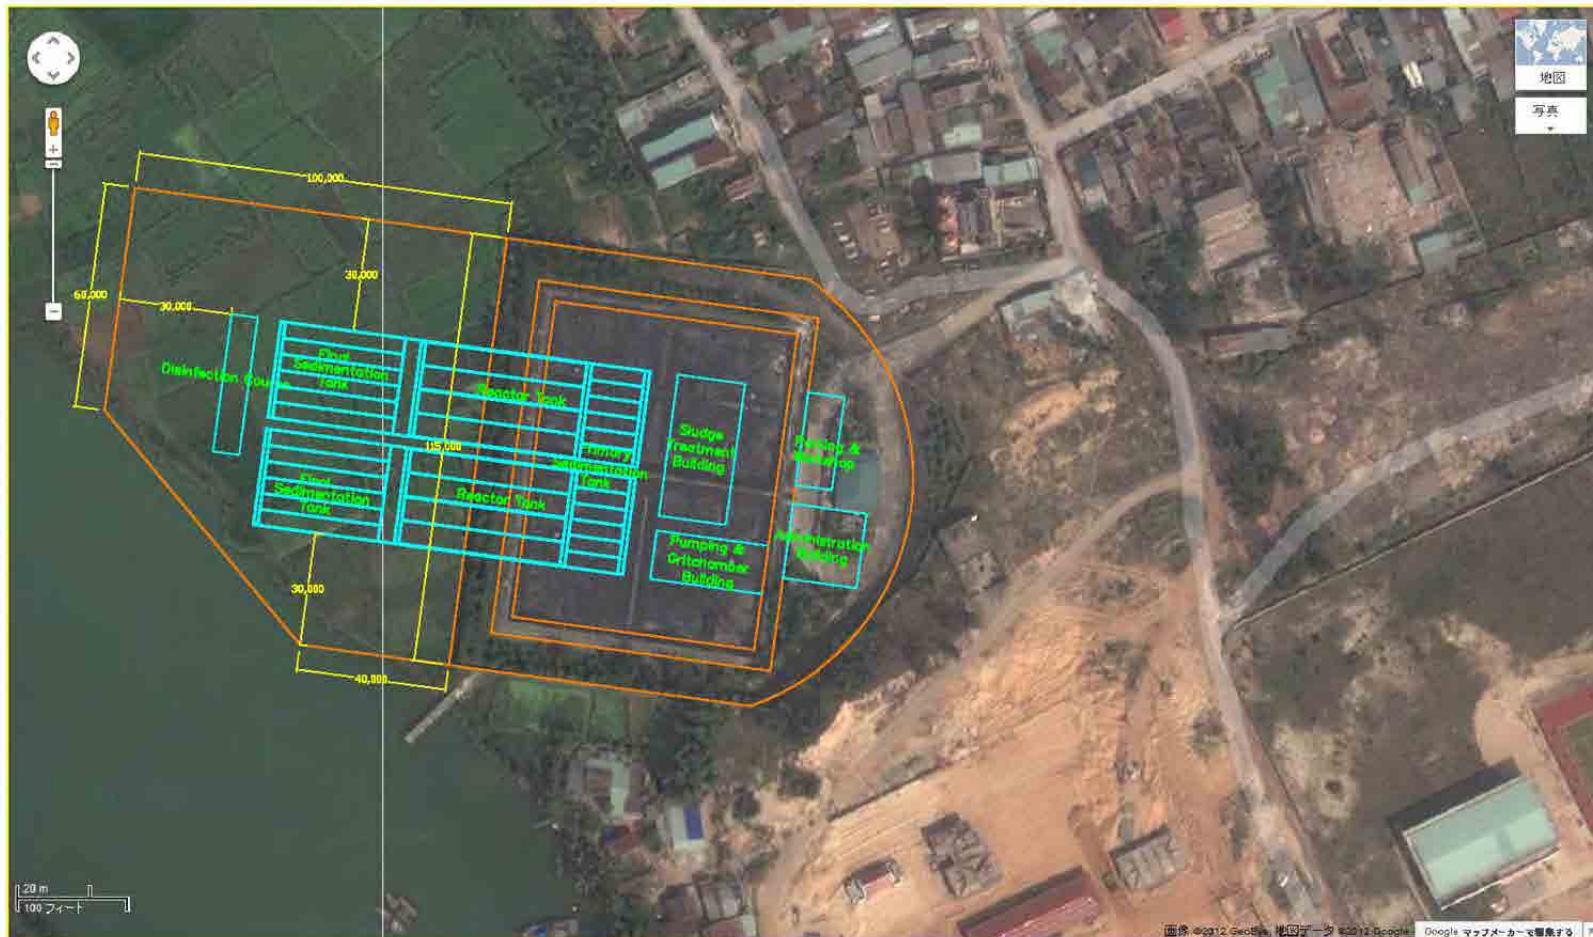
ステップ流入式硝酸銅法の処理場平面配置図
